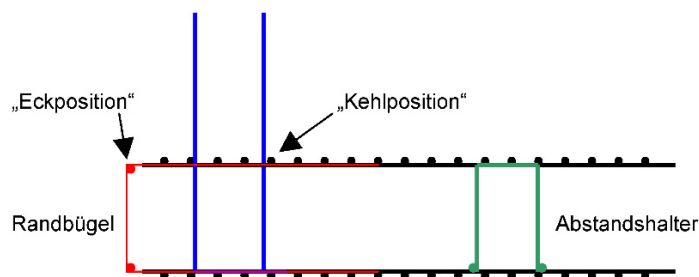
Eck- und Kehlpositionen für Außenmaße und Anschlussmaße aufgehender Bauteile im Plattengeflecht
